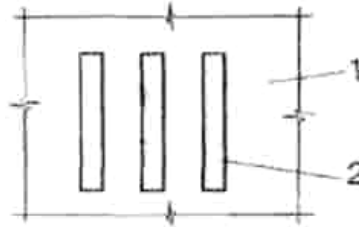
Підсилення залізобетонної плити приклеюванням зовнішньої арматури:
